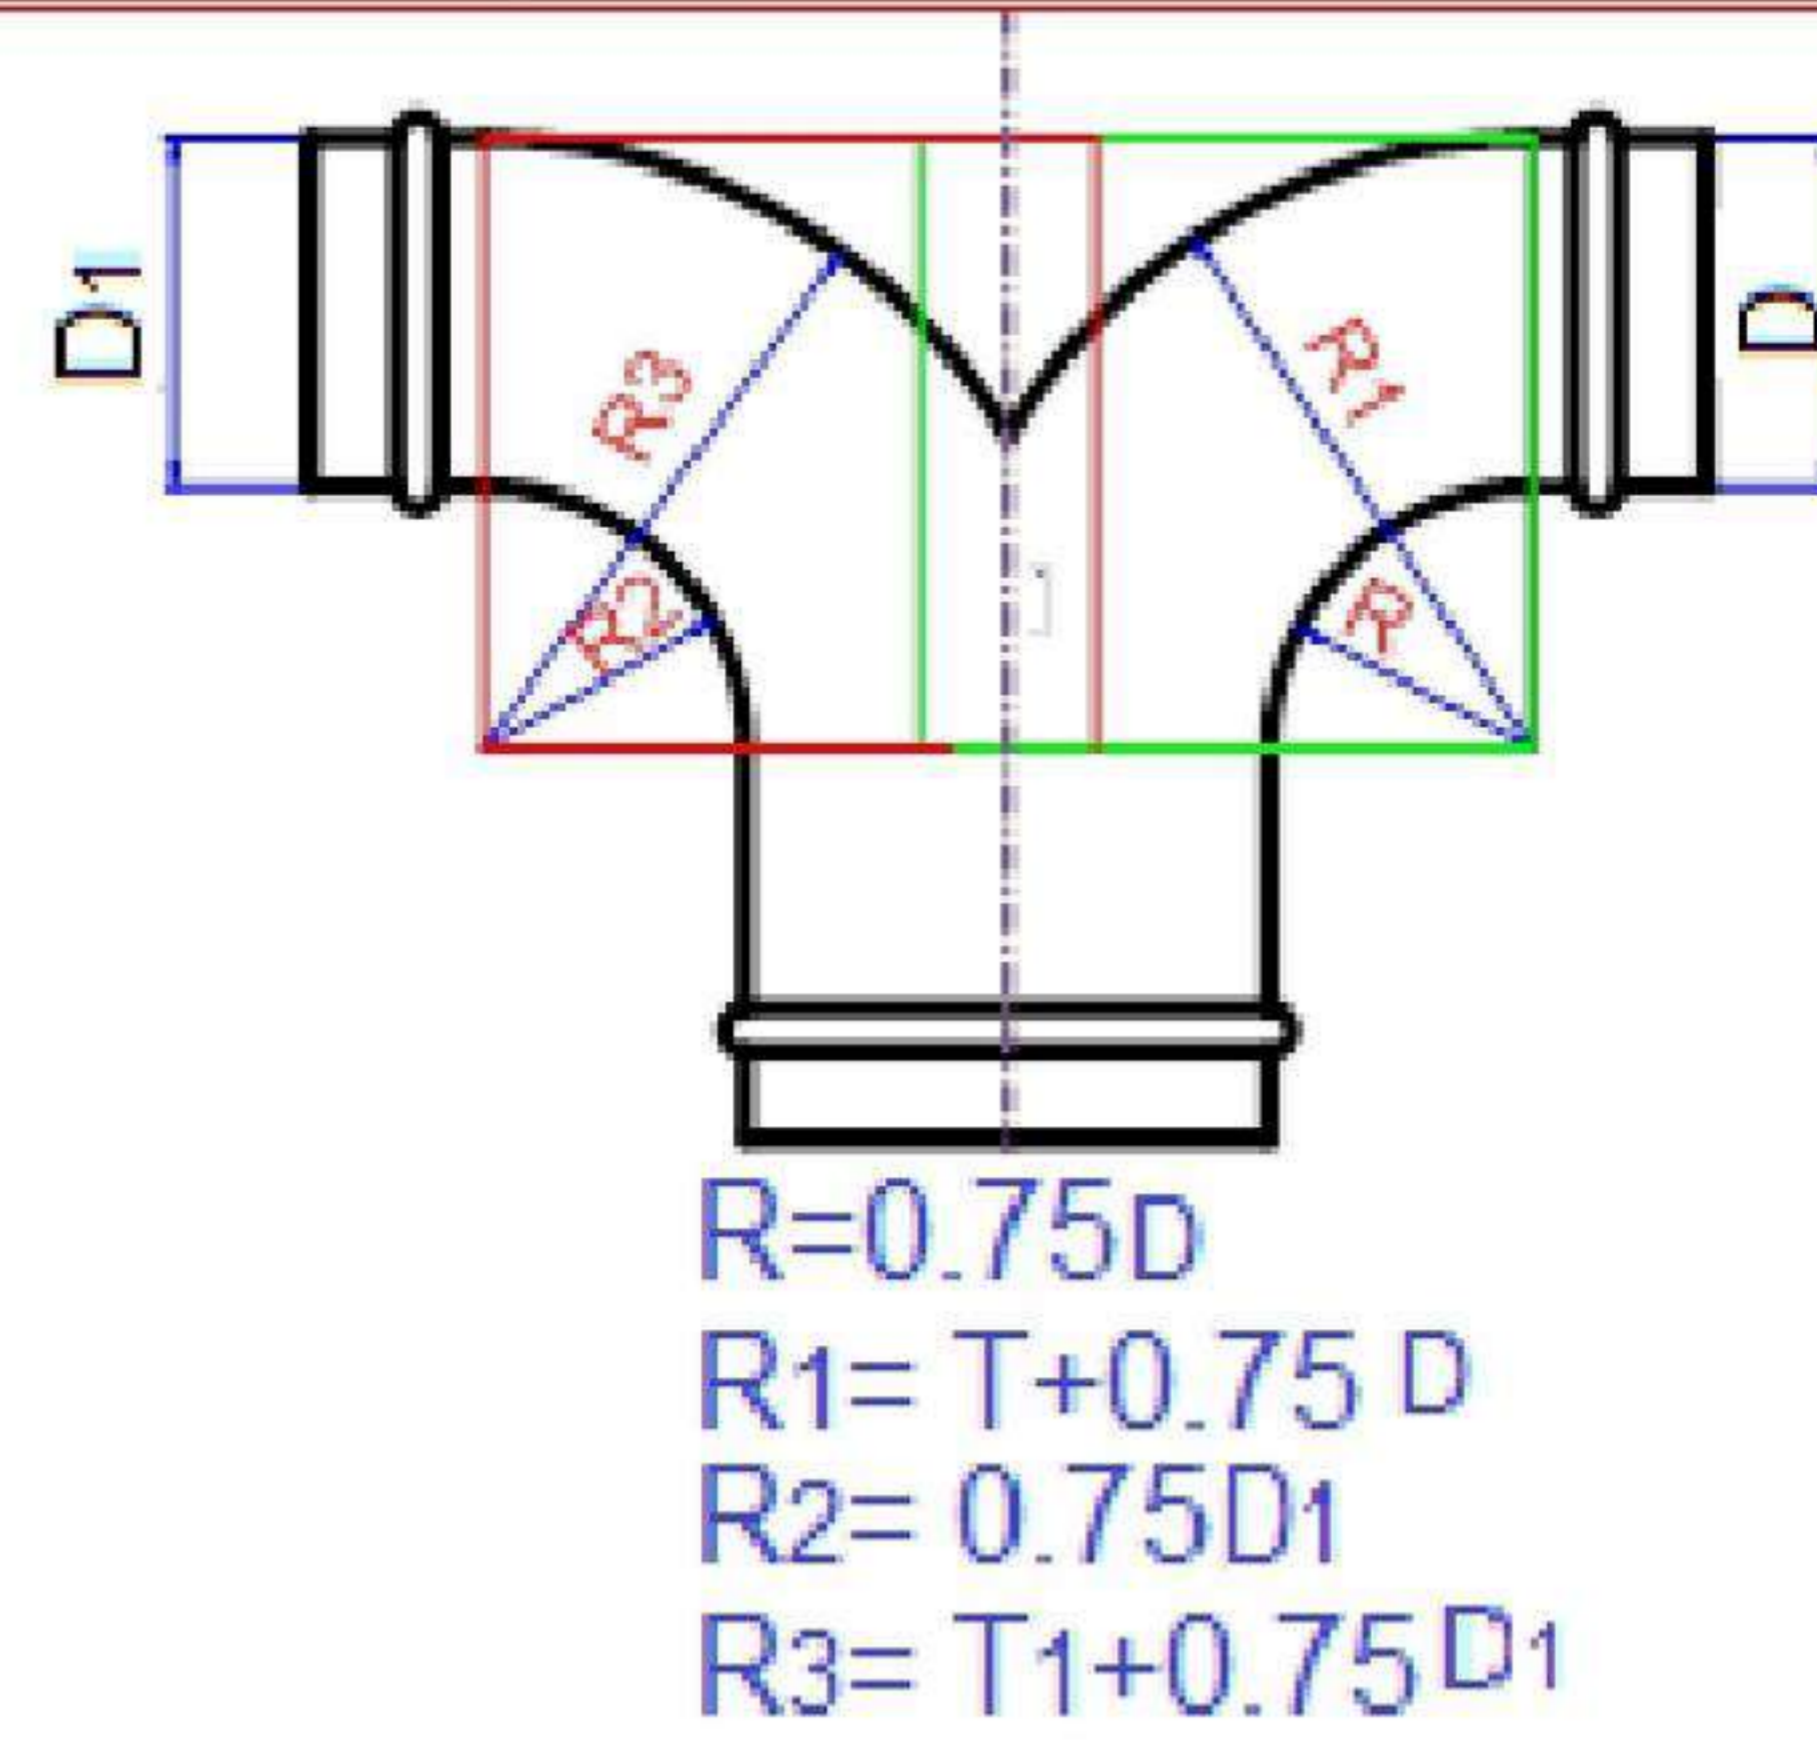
مسقط لشبكة مجرى هواء دائري المقطع
